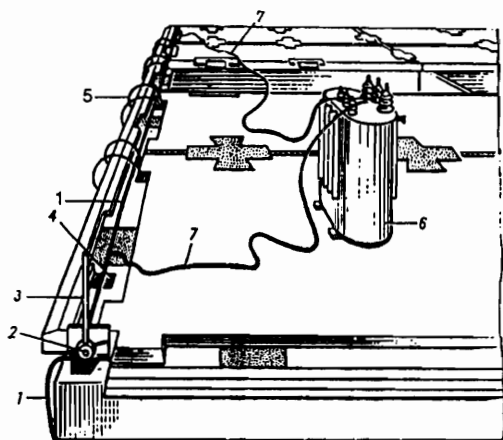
Укладка и натяжение напрягаемой арматуры: 1 – горизонтальная напрягаемая арматура; 2 – винтовое приспособление; 3 – труба-рычаг; 4 – закладная деталь; 5 – канатная арматура вертикальных стыков; 6 – трансформатор; 7 – токопроводящий канал
